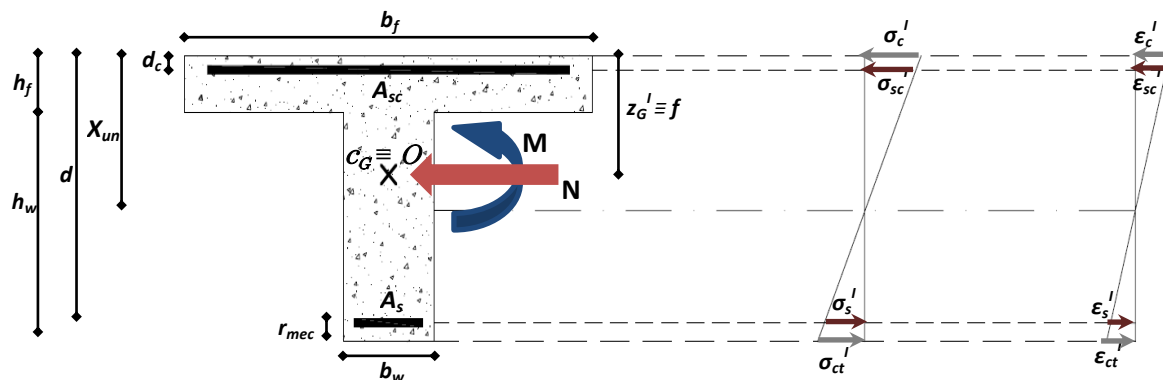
Modelo de cálculo em secção em T em estado não fendilhado
